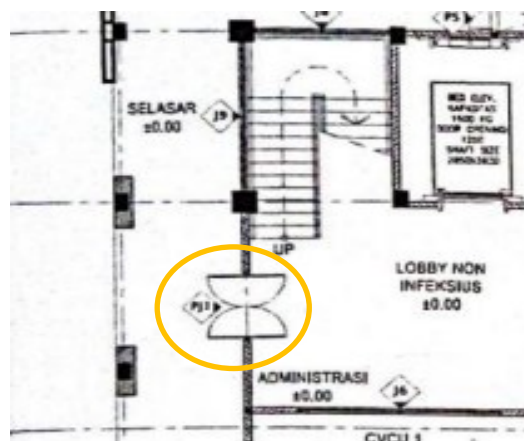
Denah Rencana Pintu Tipe P4.
